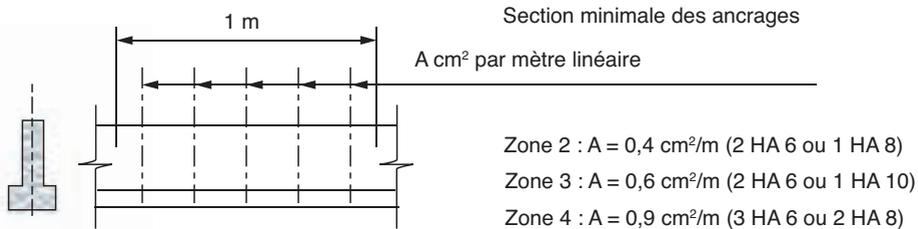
Armatures d'ancrage des murs de soubassement en béton, cas des semelles filantes (Règles PS-MI 89/92)
